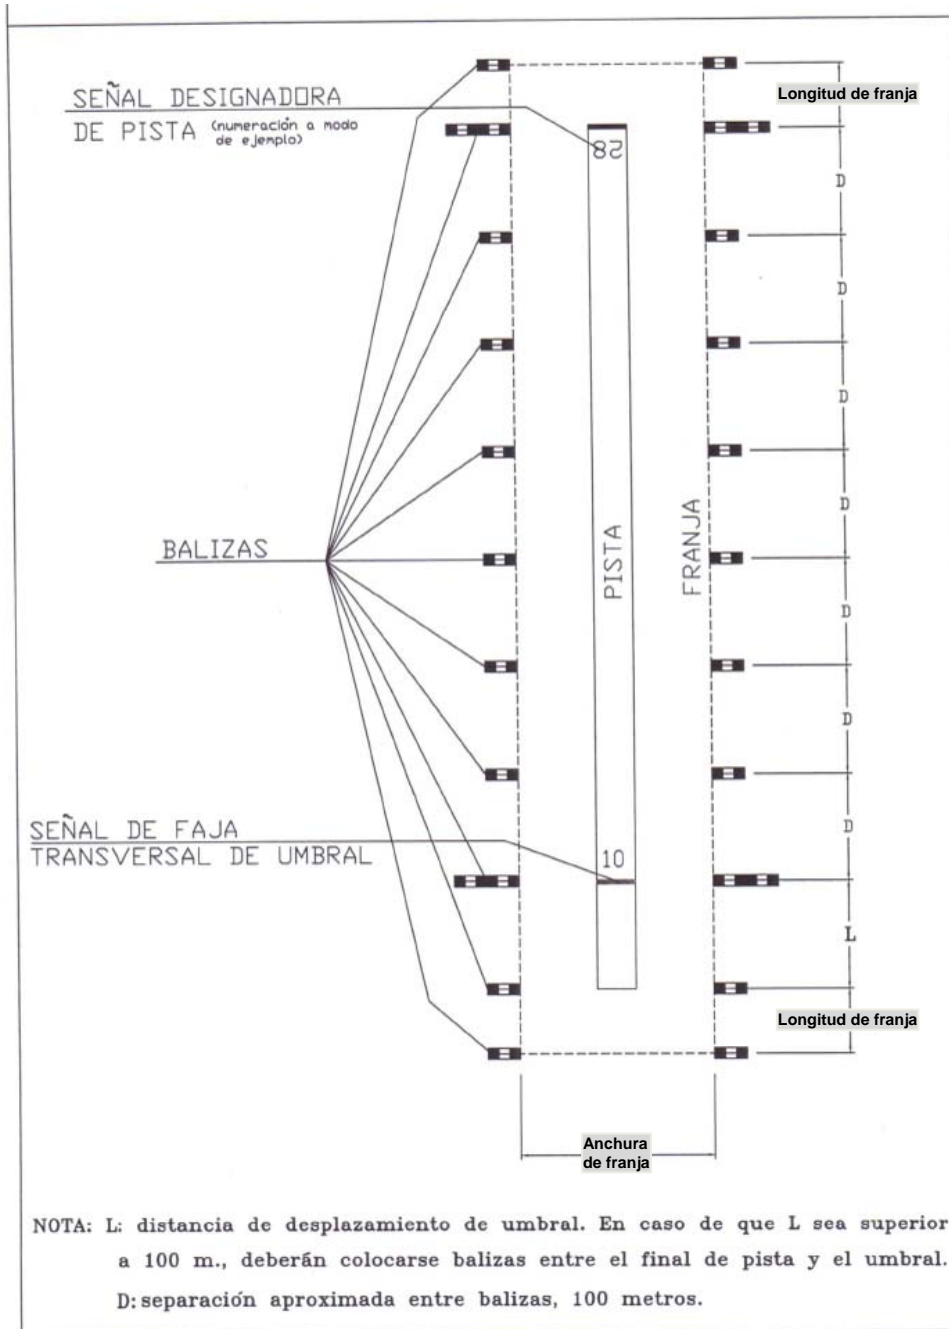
Señalización de pistas no pavimentadas con umbral desplazado. Opción B
